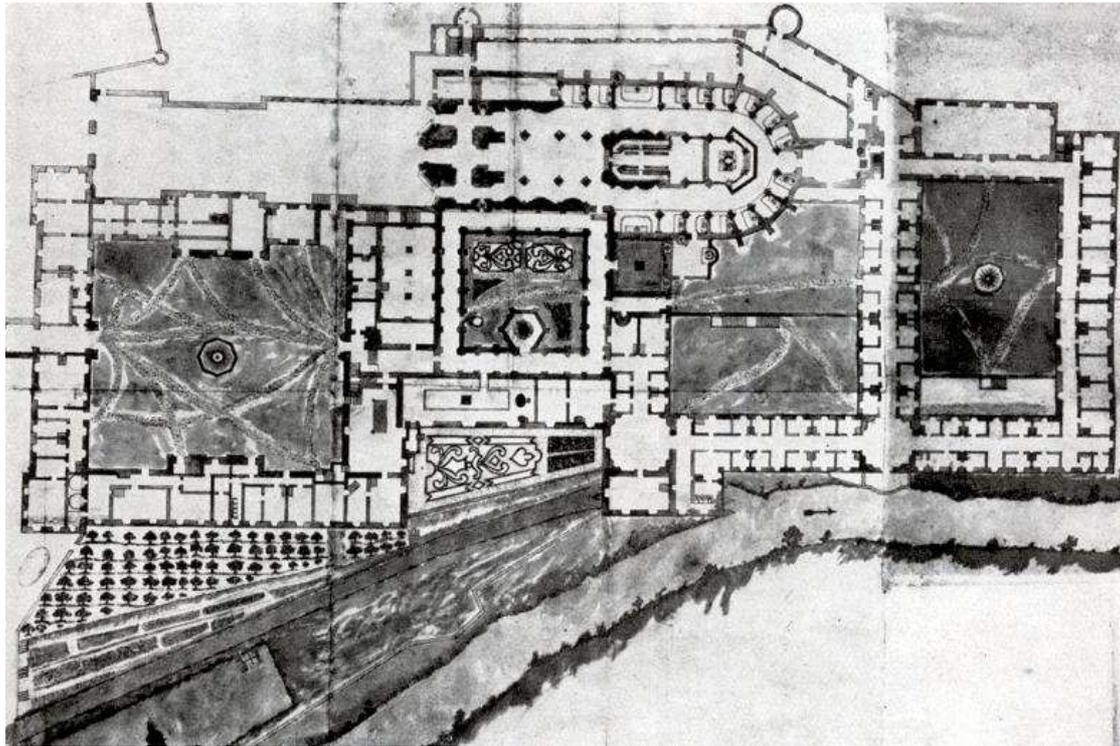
Zwettl, Zisterzienserstift Zwettl, Grundriss, Bauplane Nr. VIII
